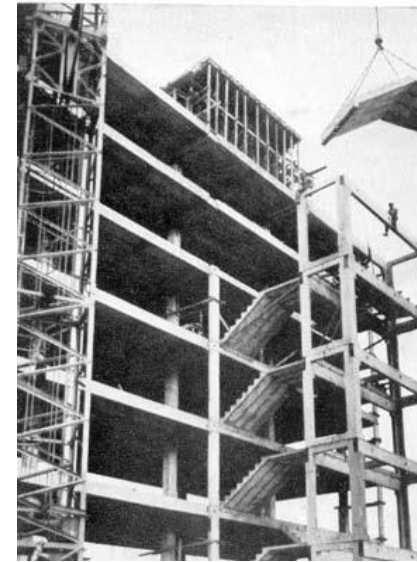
| Construção do CRUSP. Escadas pré-moldadas (fonte: Revista Acrópole, FEB 1964 - ANO 26 - N° 303, pág. 94)
